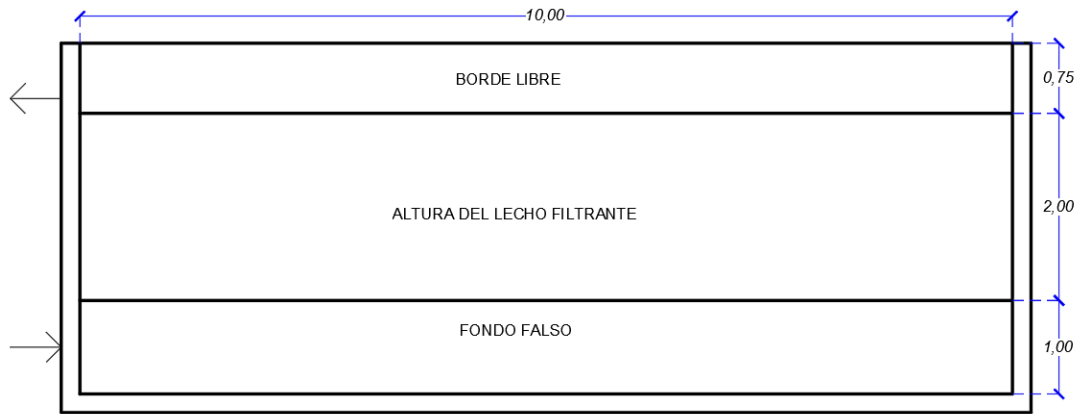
Dimensiones del FAFA propuesto vista en planta.
